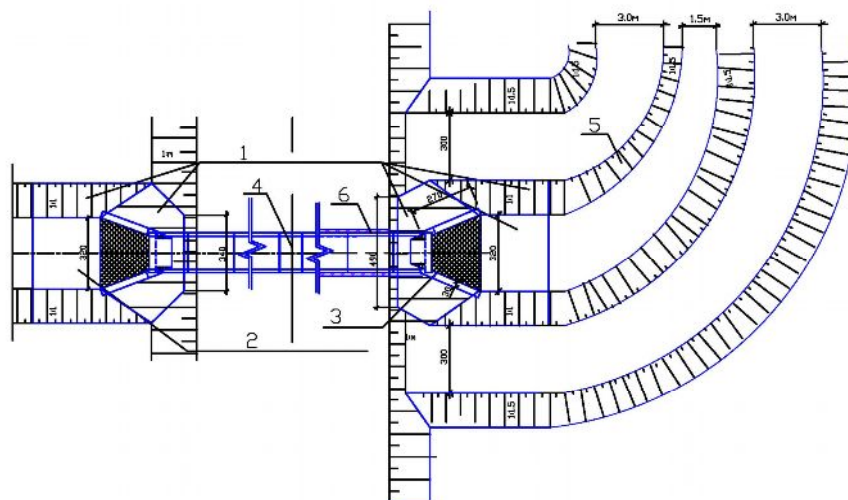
План водопропускной трубы с защитным коробом: 1-укрепление монолитным бетоном входа и выхода трубы 8см; 2- укрепление дна русла на выходе трубы 12см; 3- бетон лотка; 4- звенья тела трубы; 5- обвалование русла на входе в трубу; 6- защитный
